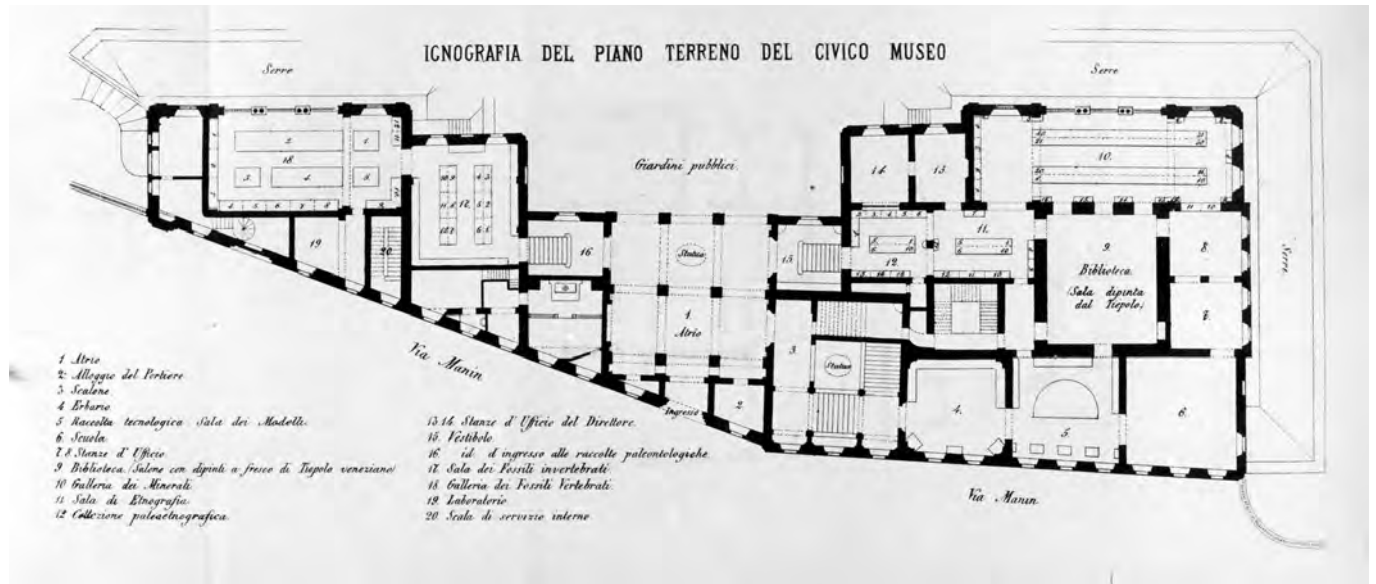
Planimetria del primo piano del Museo di Storia Naturale nelle sede di Palazzo Dugnani, 1870. / Plan of the first floor of the Museo di Storia Naturale in Palazzo Dugnani, 1870. Archivio fotografico MSNM.
